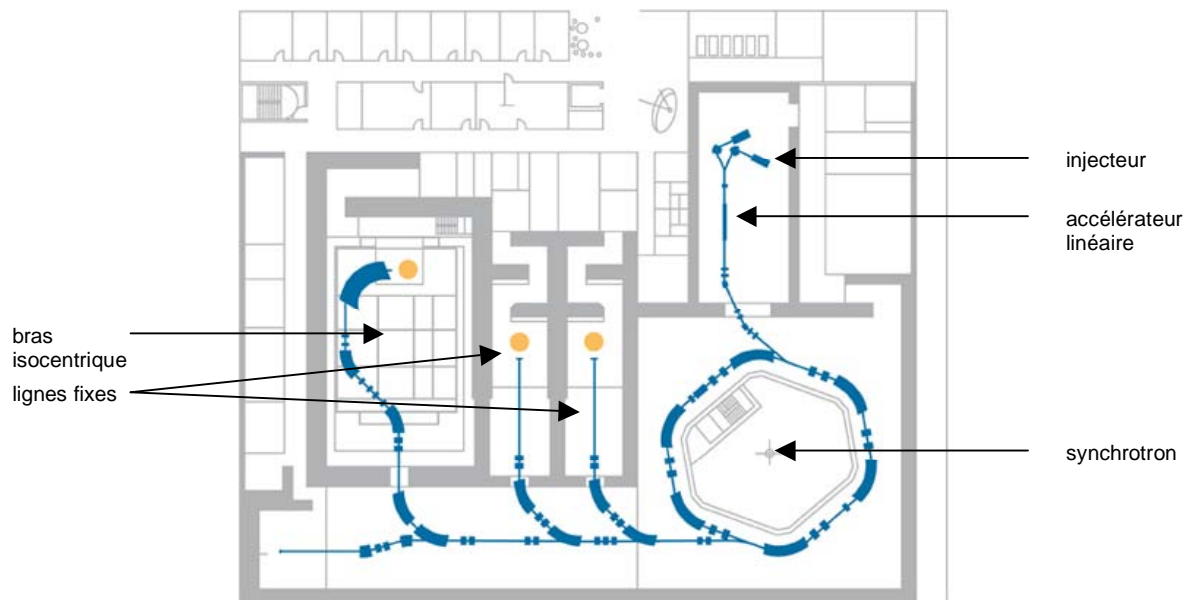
Plan de l'HIT Center : source : site web du GSI
